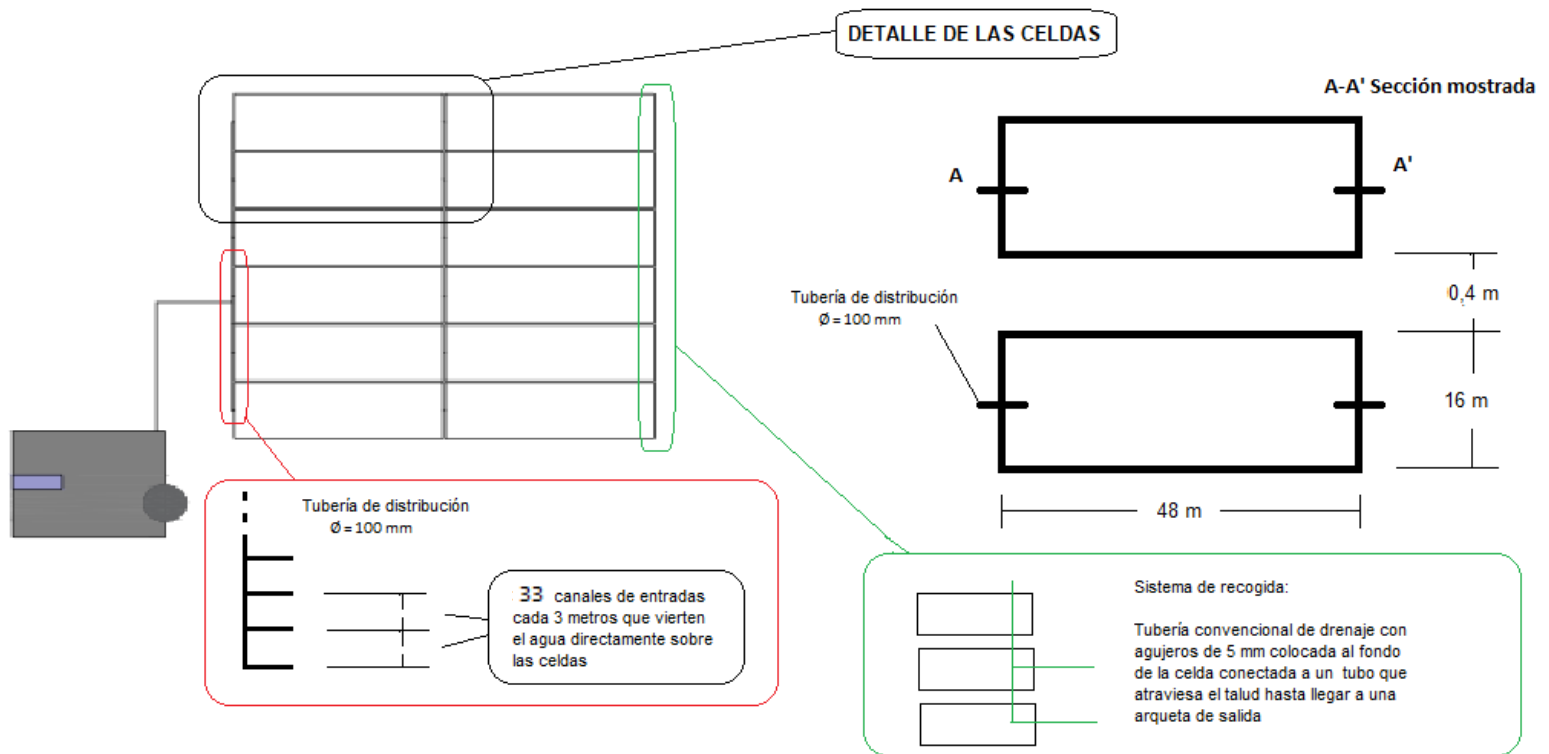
Imagen que muestra la disposición de las celdas del humedal (no a escala). Fuente propia
